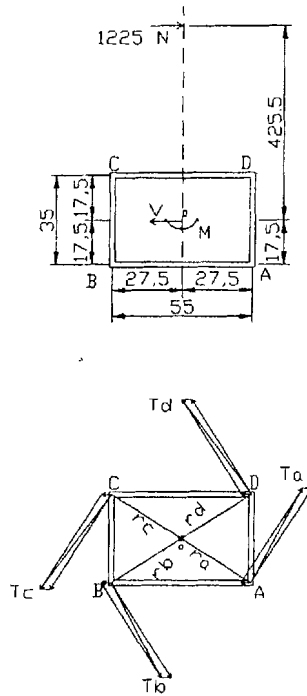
Cálculo de la Soldadura de la Columna.
